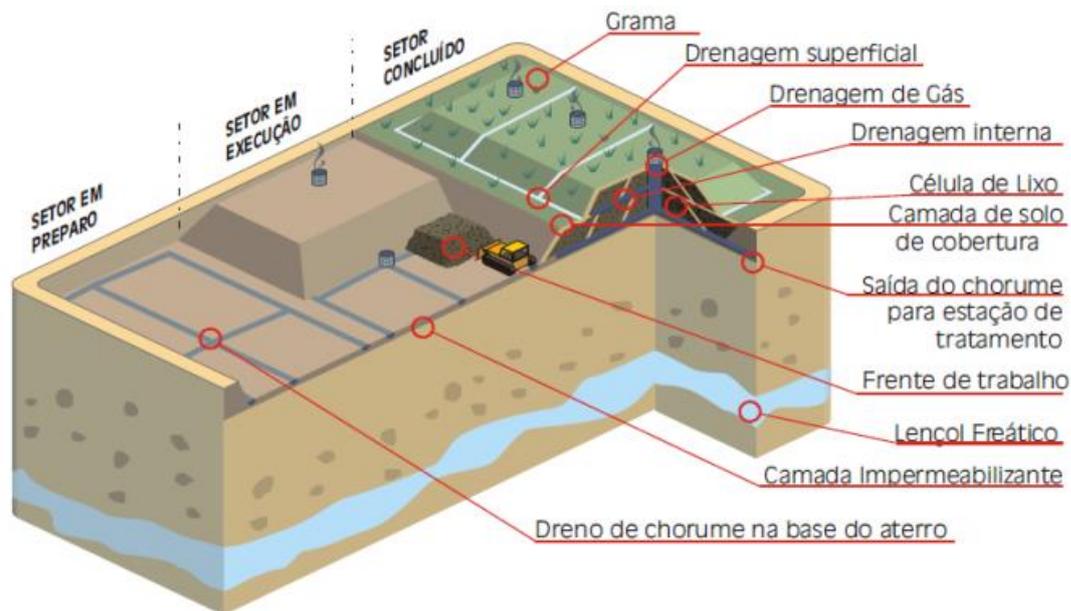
Esquema de um aterro sanitário, com detalhamento de suas estruturas.
